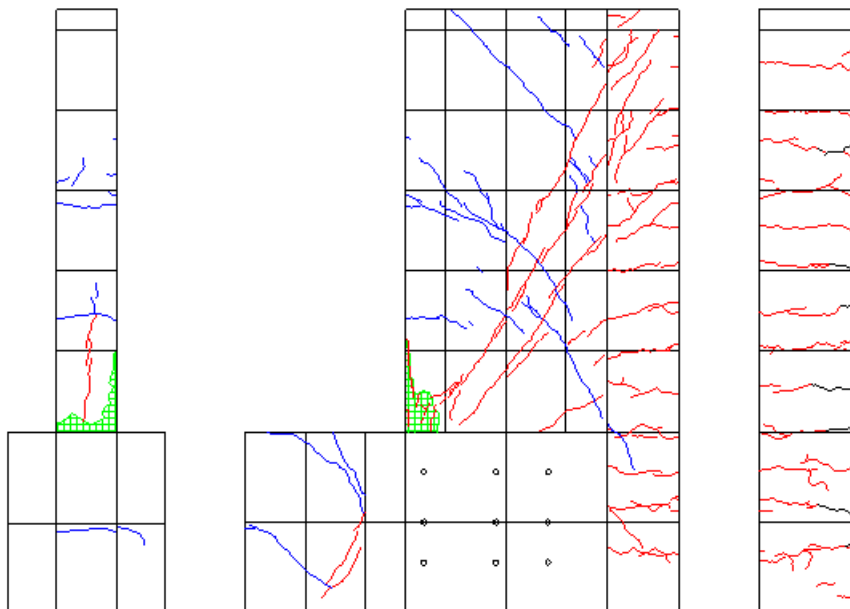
R=-1/67②ひび割れ図
